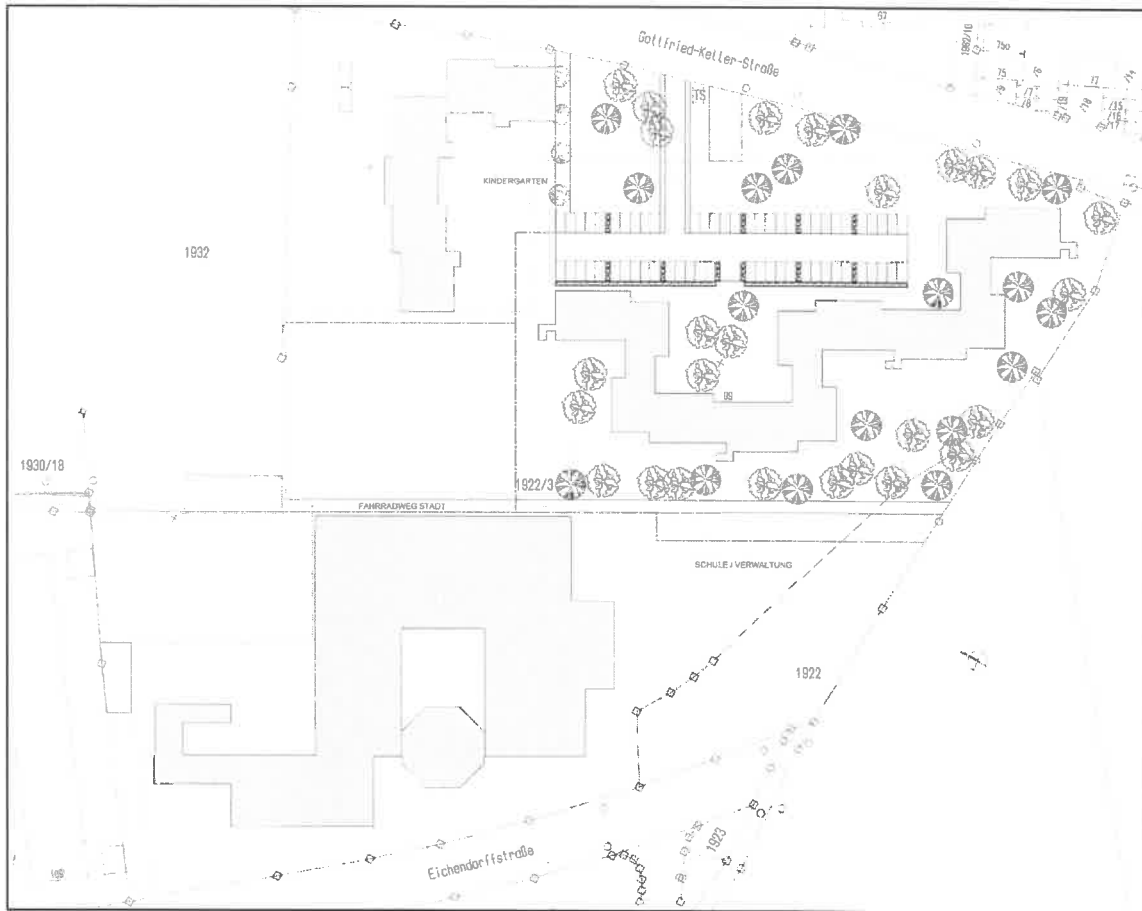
Grundriss des oberirdischen Parkplatzes
